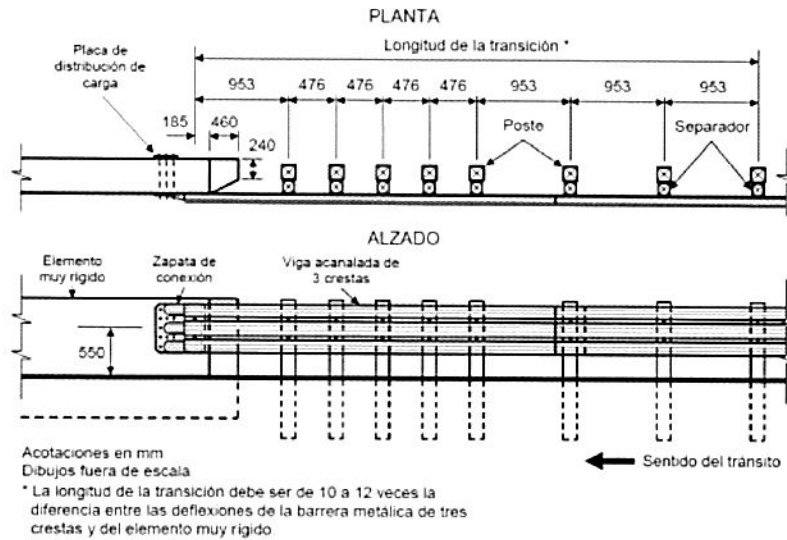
Transición de barrera metálica de tres crestas a muro vertical recto
